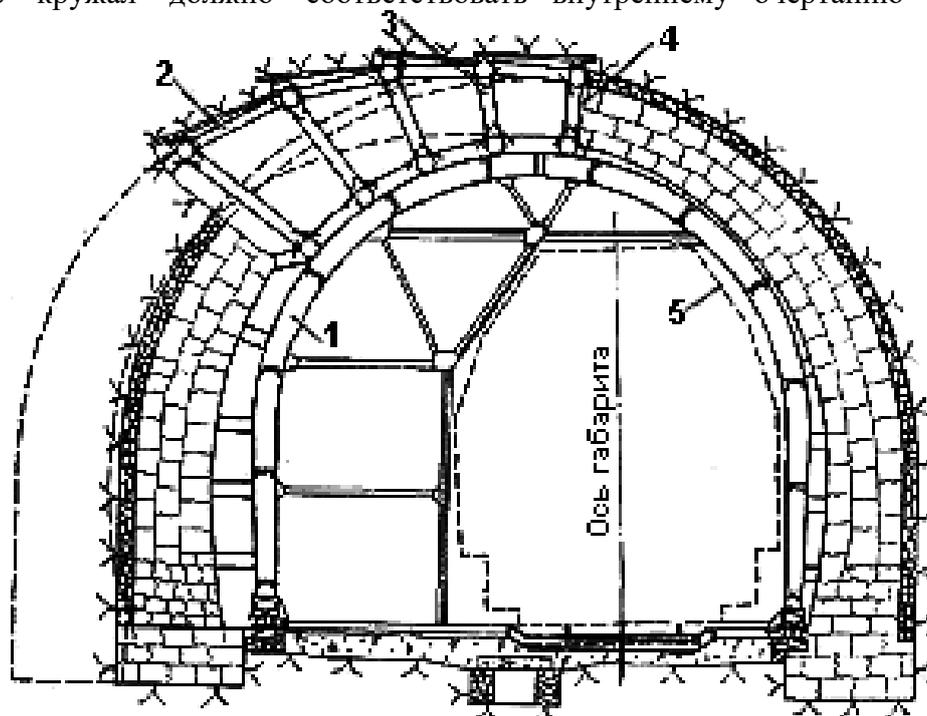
Разборка негабаритной кладки и доборка профиля: 1 – металлические несущие кружала; 2 – рошпан; 3 – штендер; 4 – граница разборки негабаритной кладки; 5 – линия габарита приближения строений
